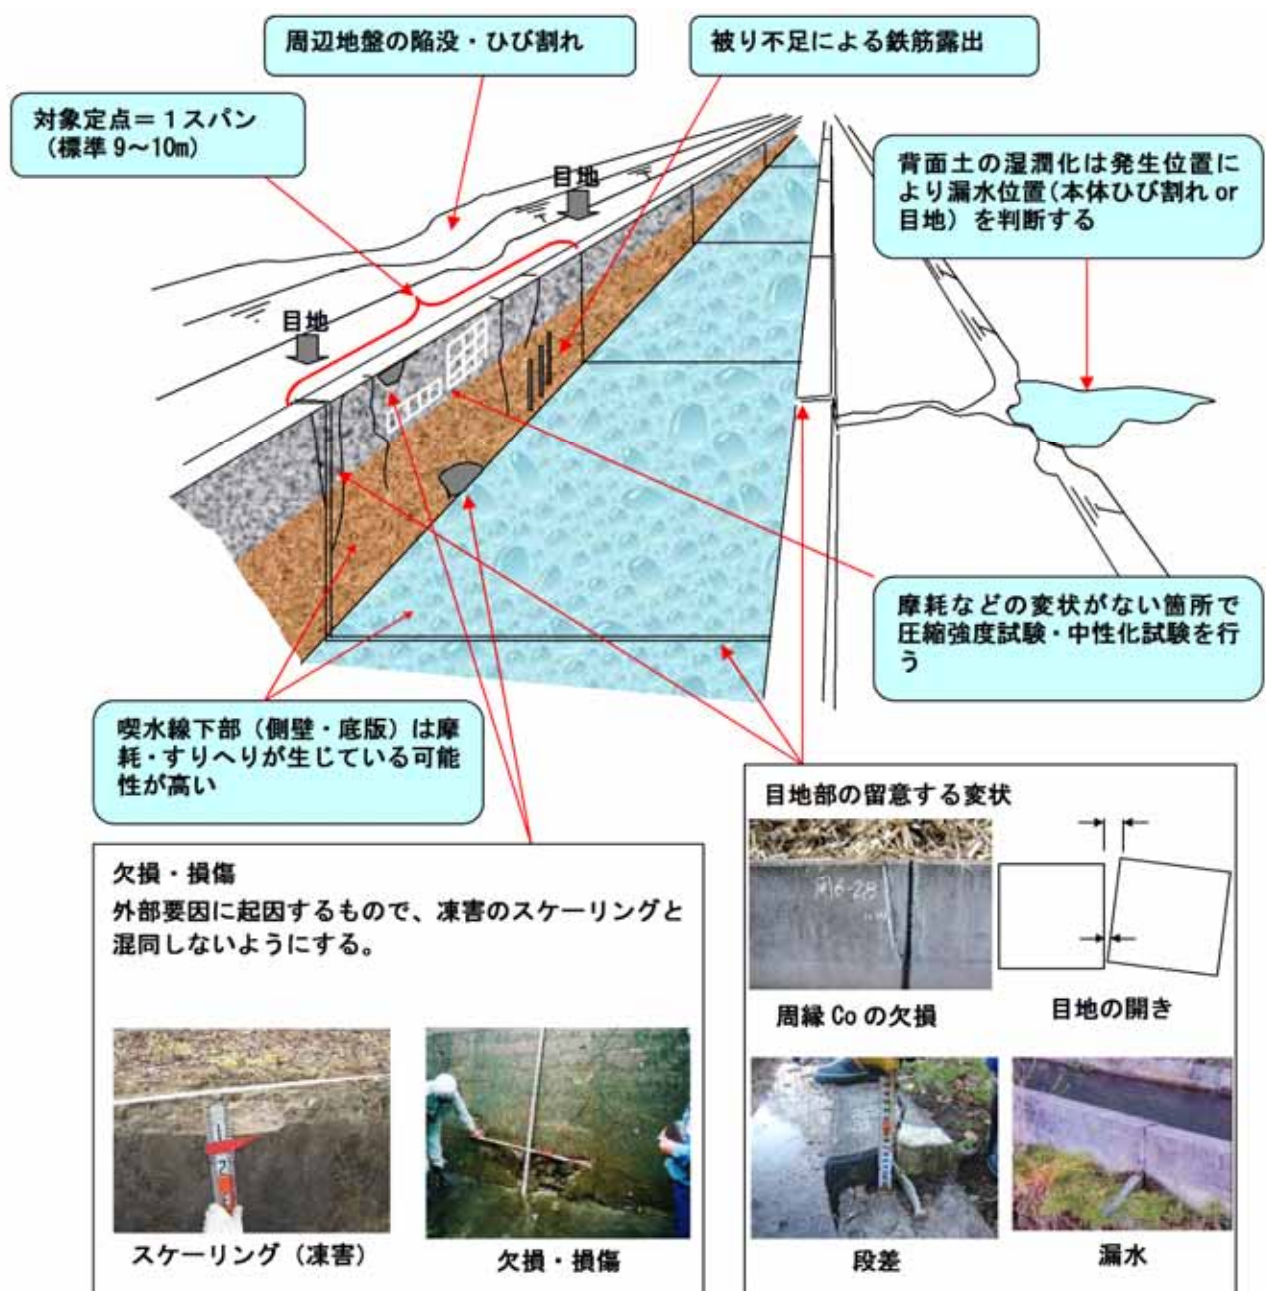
鉄筋・無筋コンクリート水路調査のポイント
